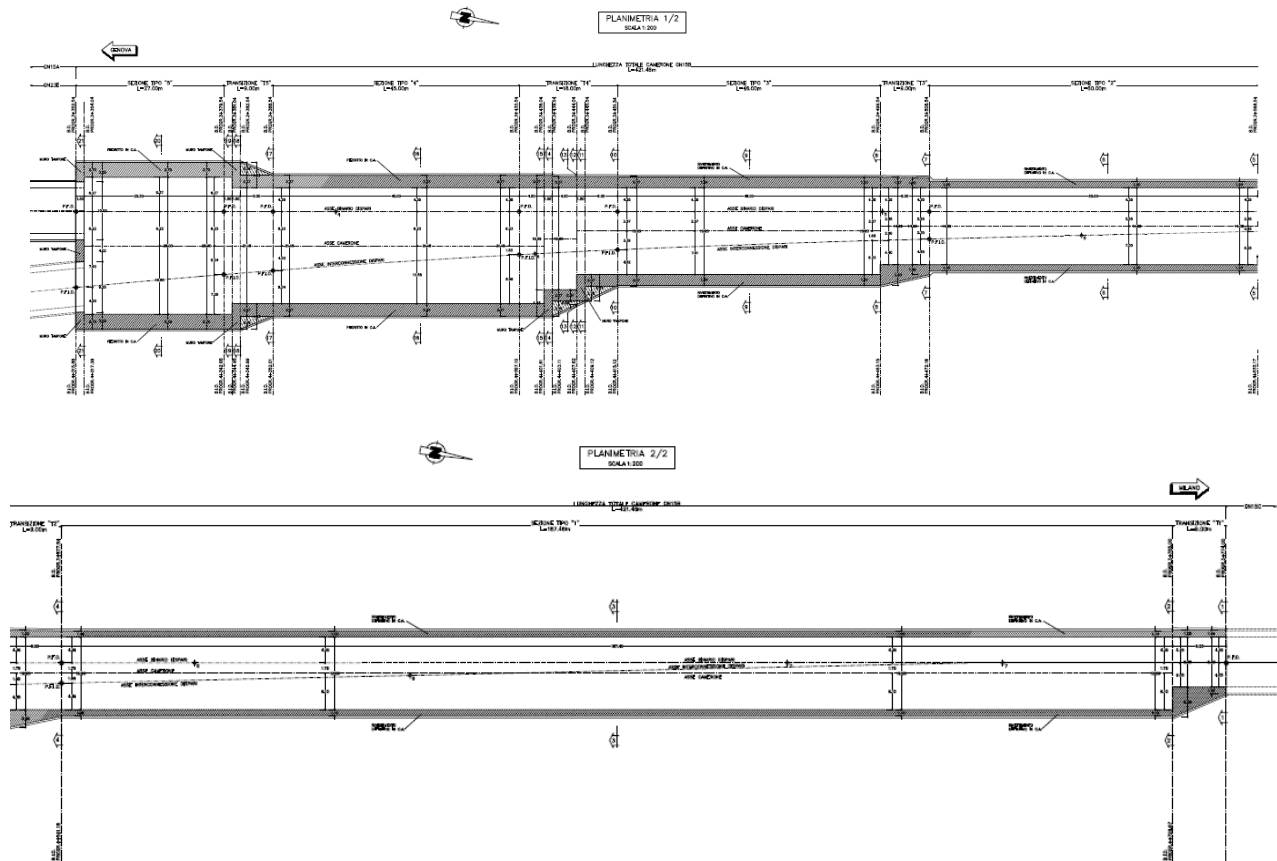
Sezioni tipo Camerone previste da Progetto Esecutivo
